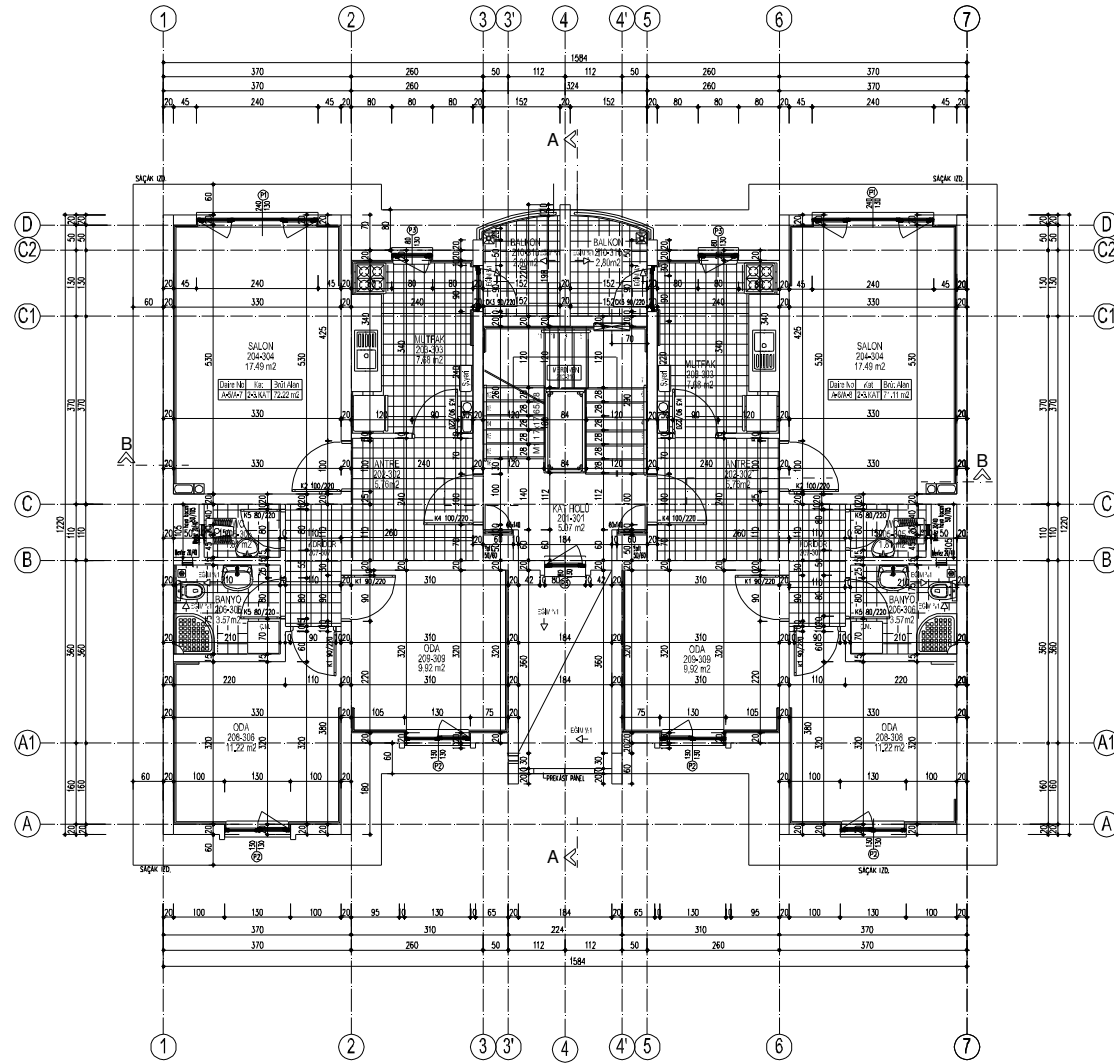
2 nolu Proje Bodrum Kat Planı
